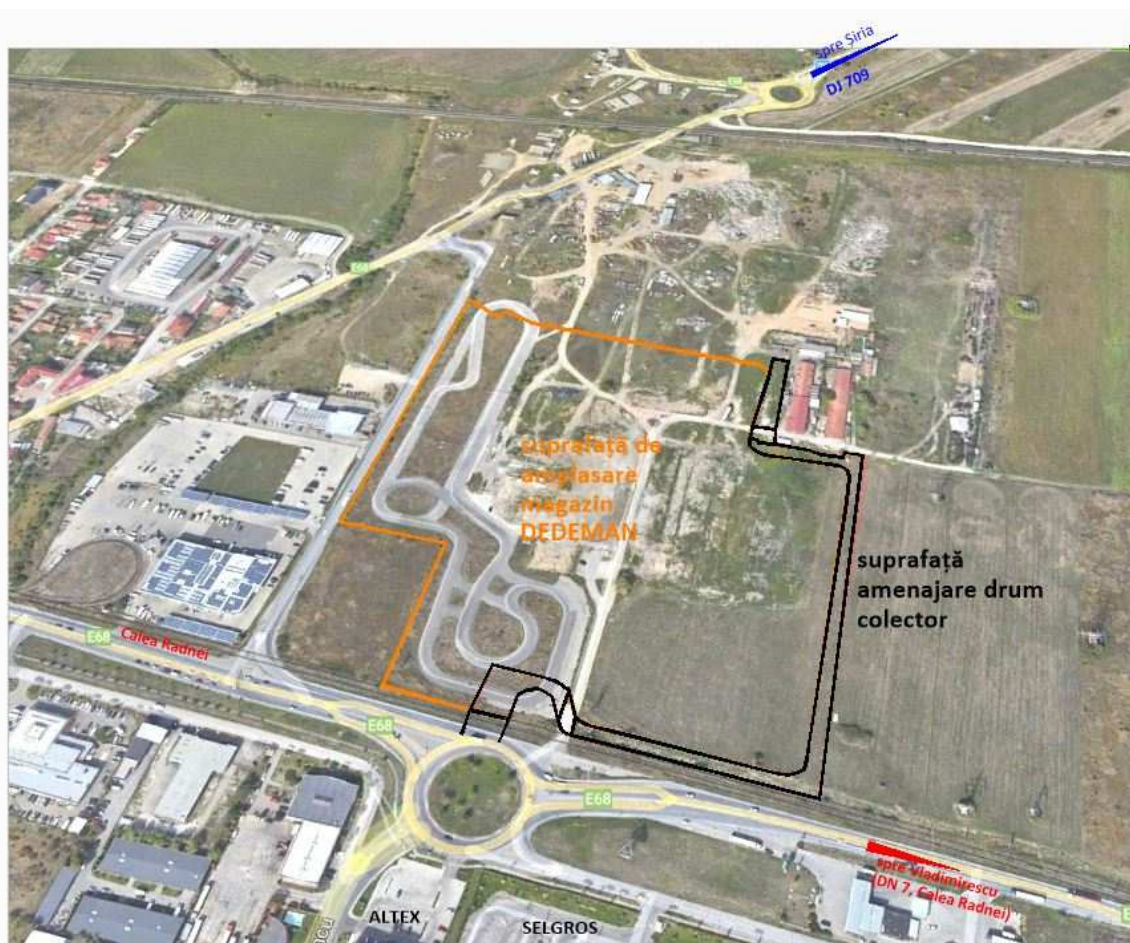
Zona Calea Radnei – Strada Șiriei, Arad, amplasare platformă magazin bricolaj și drum colector
